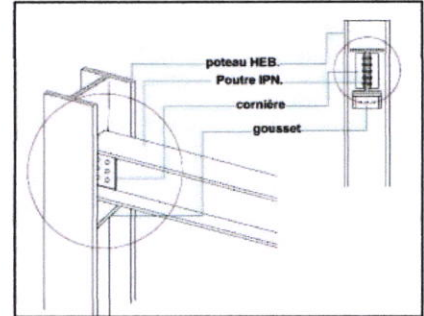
assemblage poteau poutre ; source : auteurs 2018.
